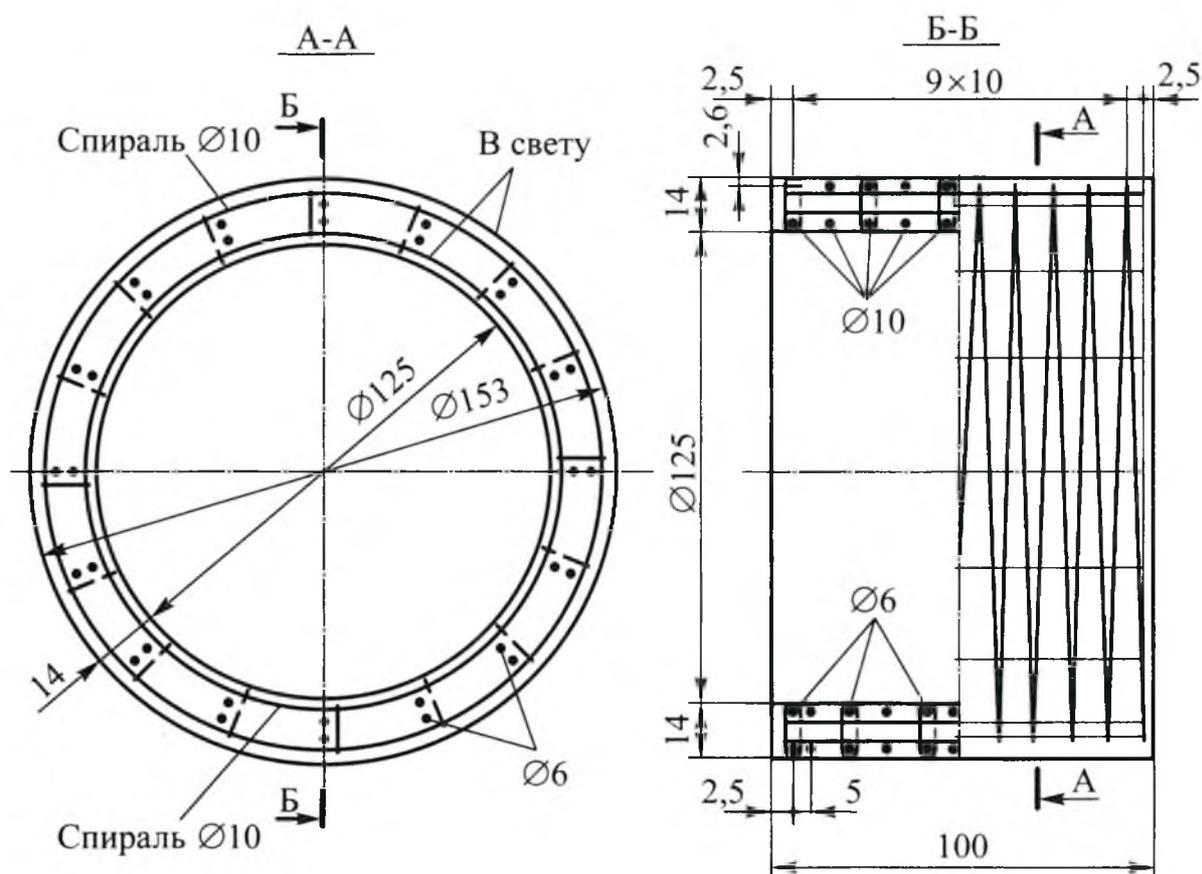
Армирование круглого звена трубы диаметром 1,25 м для высоты насыпи железной дороги до 7 м
